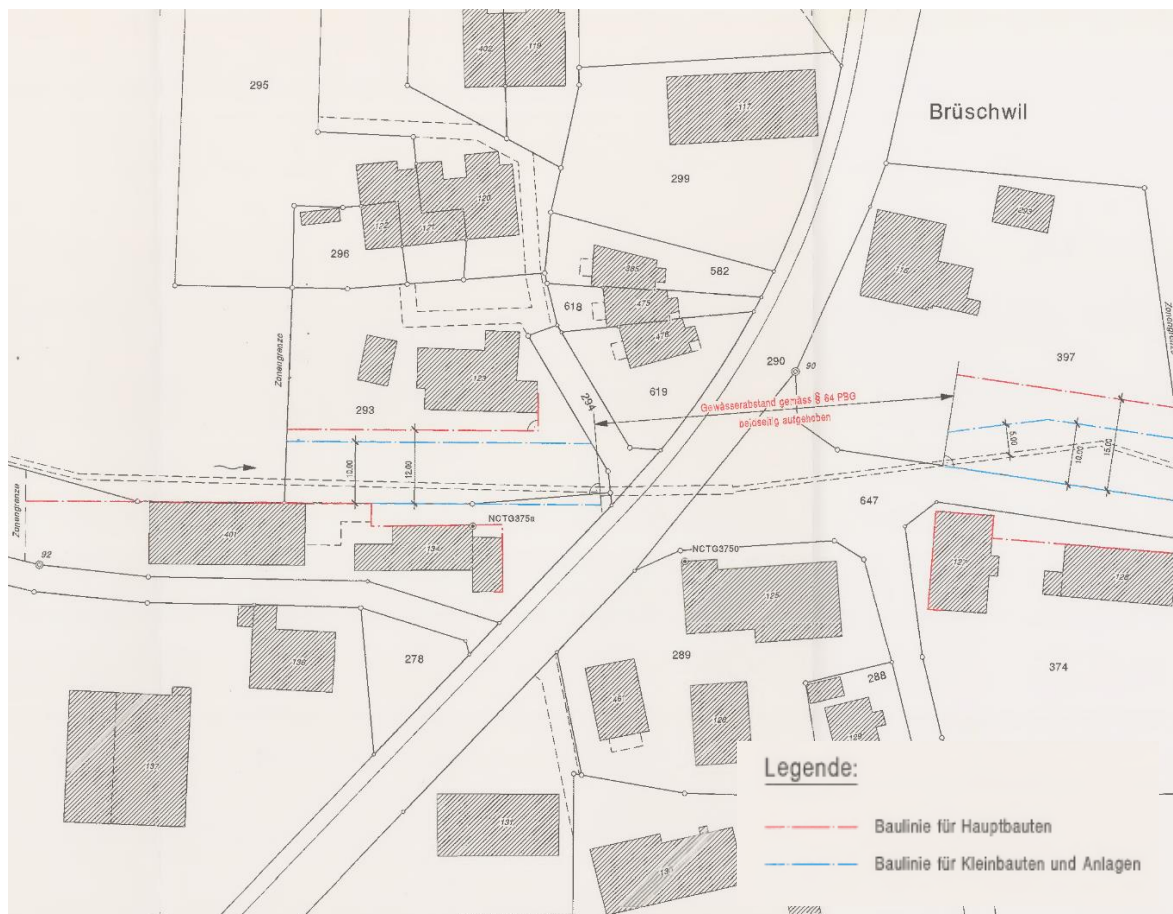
Ausschnitt des Baulinienplans Brüschwilerbach
